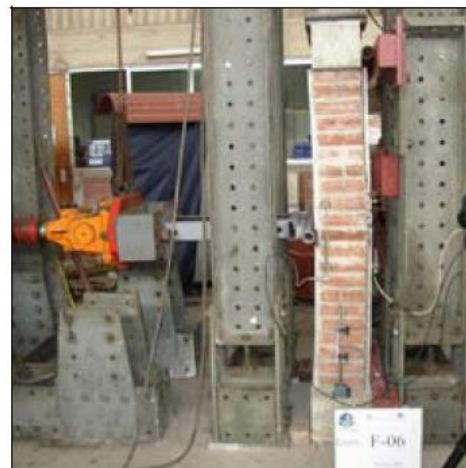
Ensayo de paneles a corte-compresión; Imagen 3.2.2-4. Ensayo de paneles a flexión.
